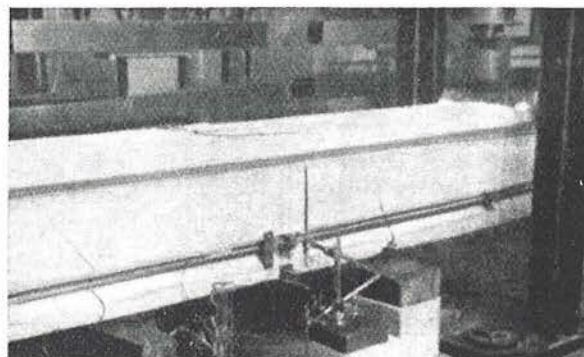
Fisuras de la viga 23 bajo la carga 2x1,8P.
